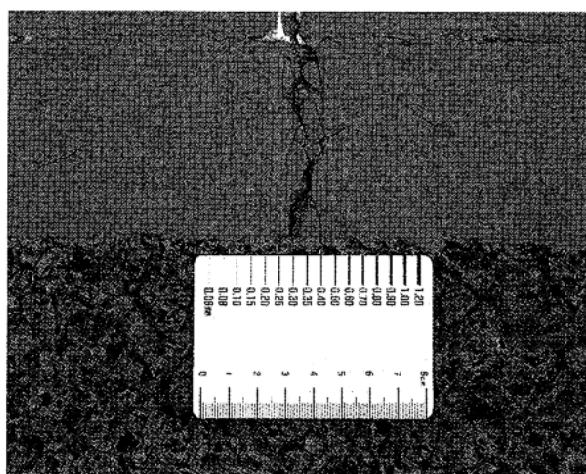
ひび割れ状況 (センターライン上でのひび割れ測定)
